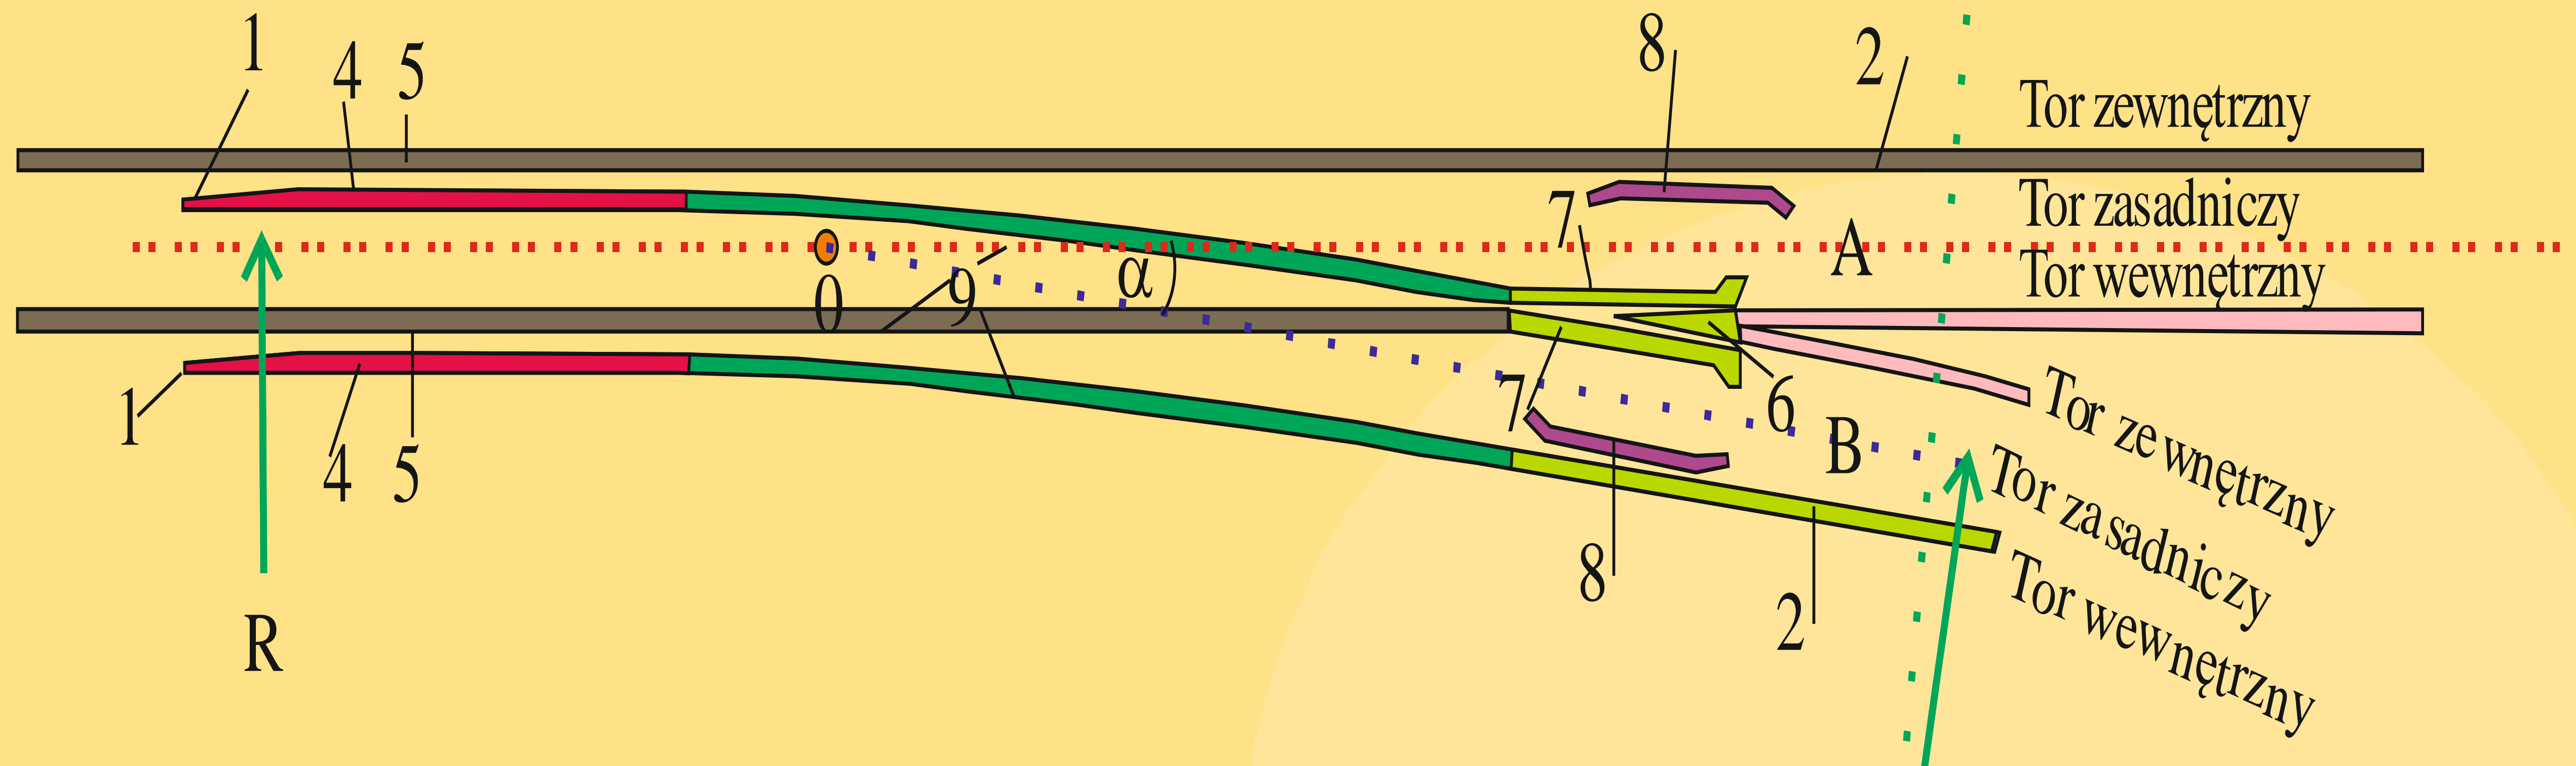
Zwrotnica rozjazdu zwyczajnego Rz 60E1 – 300 – 1:9 ssbP
